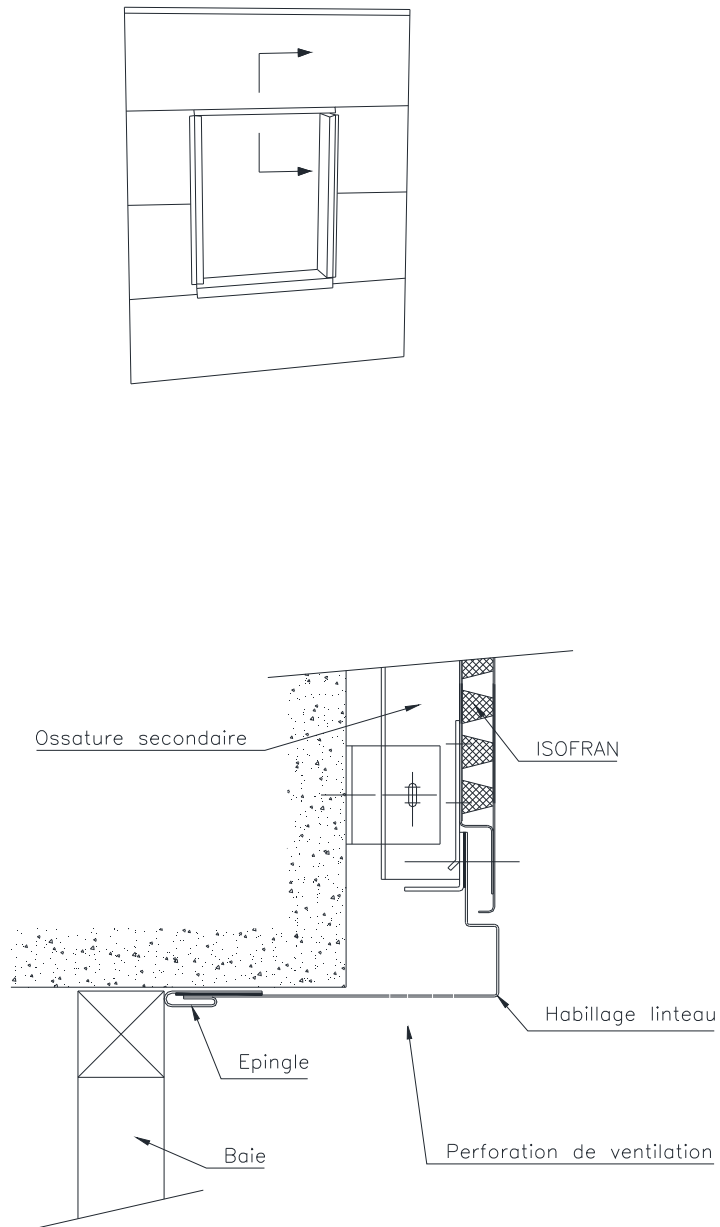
Panneau ISOFRAN Pose horizontale - Linteau
